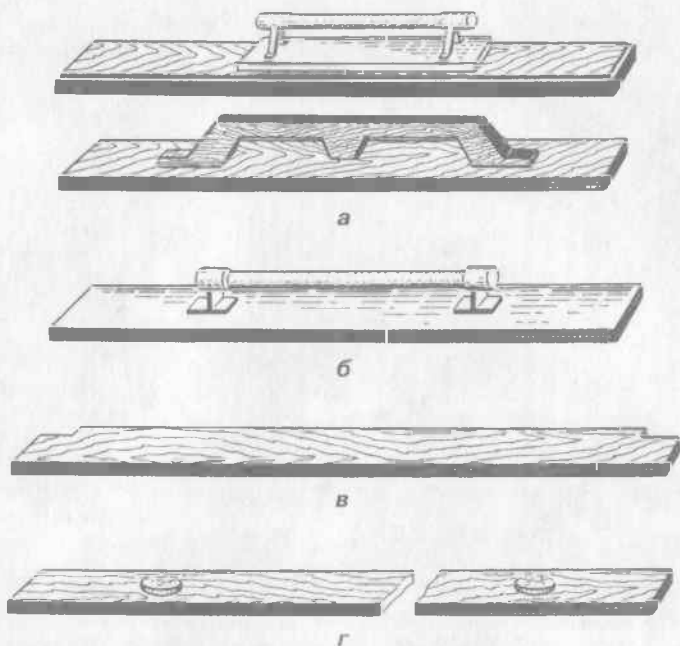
Інструменти для розрівнювання й оброблення нанесеного на поверхню штукатурного шару:
